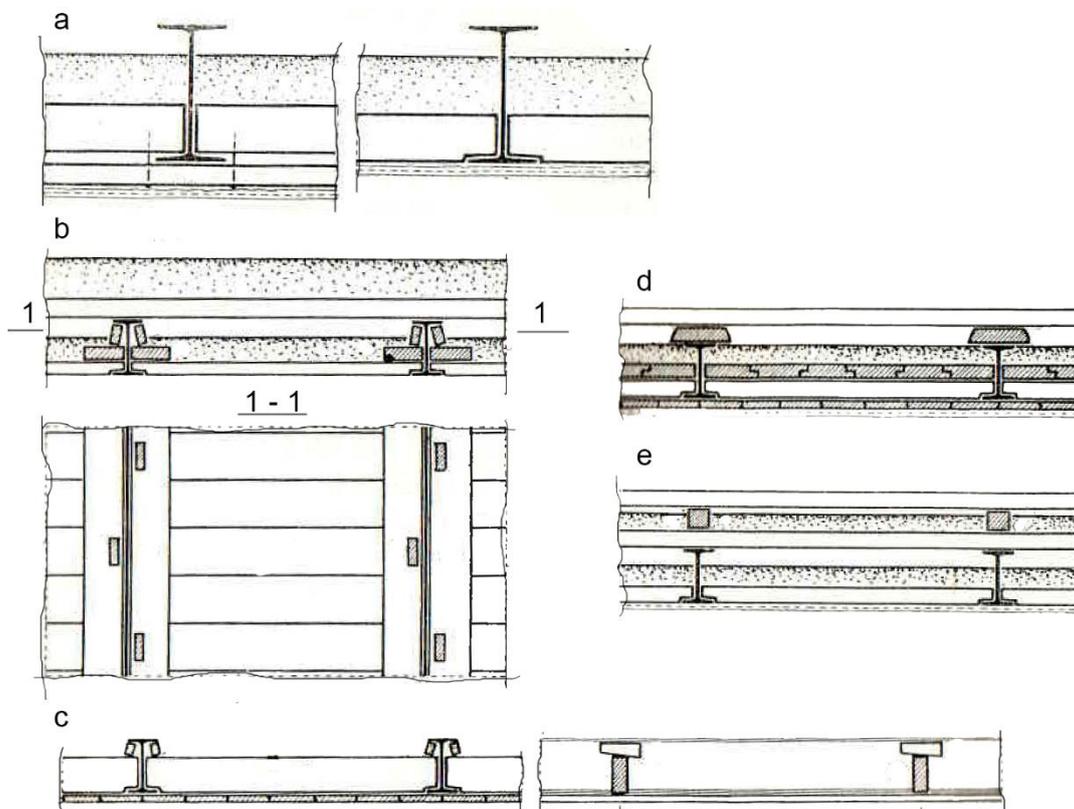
Потолки в перекрытиях по металлическим балкам: а – оштукатуривание по подшивке к доскам черного пола (слева) и оштукатуривание по драни (справа); б – оштукатуривание подбора, прижатого к нижнему поясу балок, планками, расклиненными от верхних поясов; с – оштукатуривание подшивки, закрепленной к расклиниваемым кобылкам; d – конструкция подвального перекрытия; e – конструкция междуэтажного перекрытия с двойным черным полом [33]
